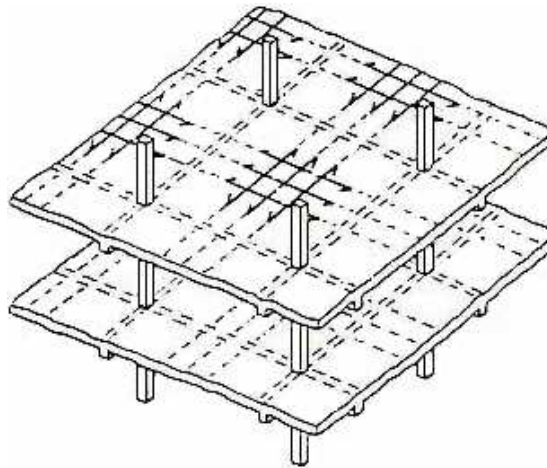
Forjado bidireccional transmitiendo las cargas a las vigas en dos direcciones
